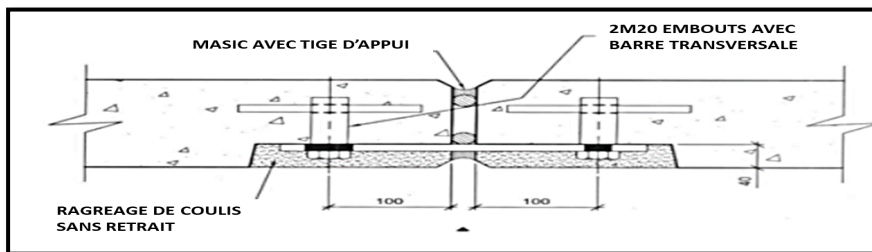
assemblage de plancher TT (type-de-connexion s.d.)
